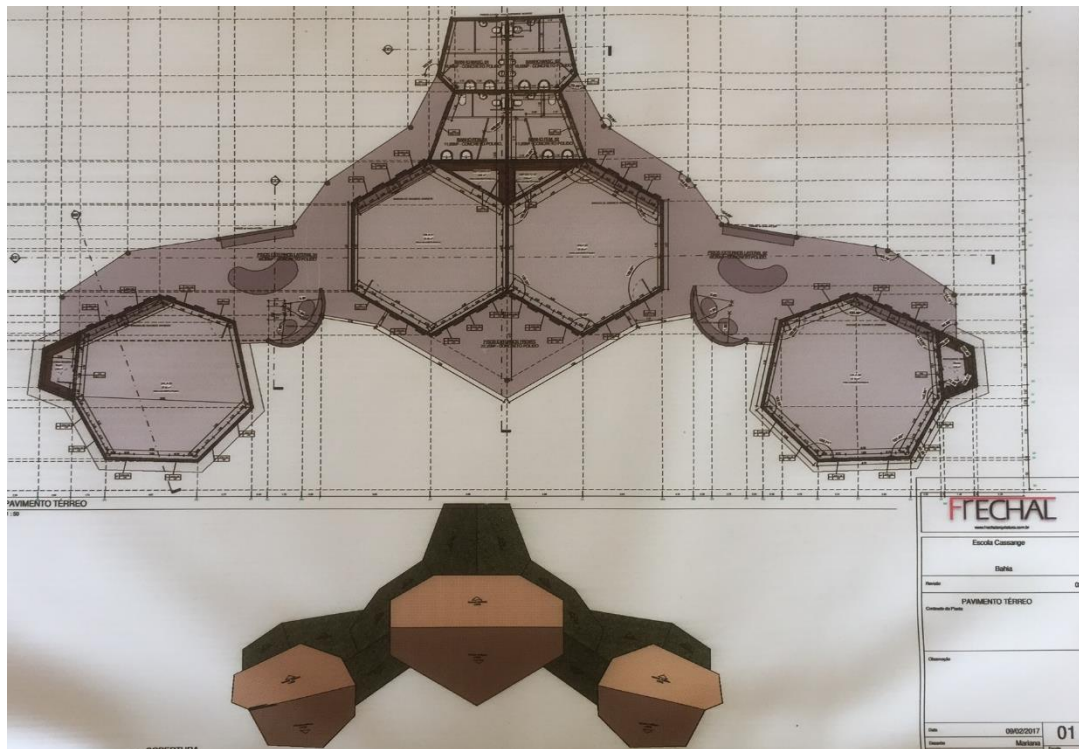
Plan des Schulhauses MarAmar. Die Dachflächen sind so geplant, dass sie sich optimal für die Installation einer PV-Anlage eignen.
